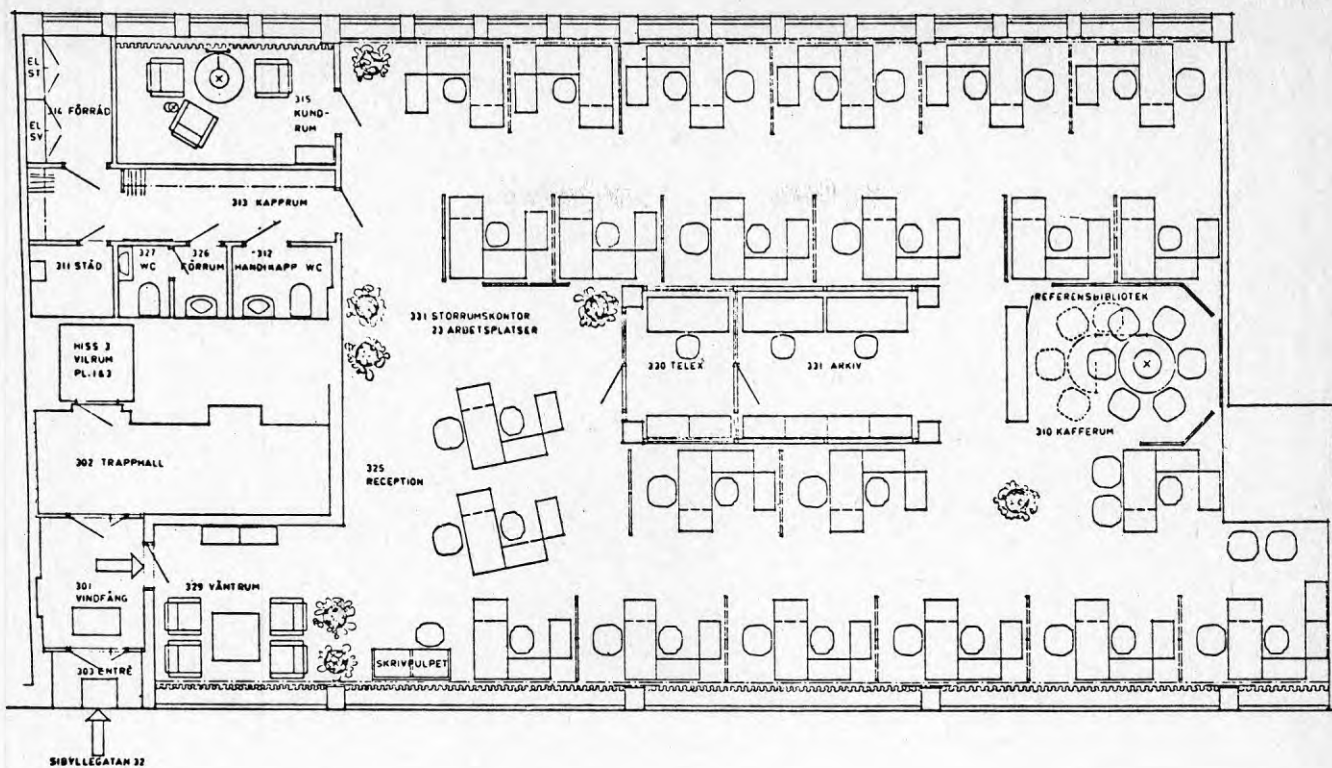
Storrumsplan. Alternativ 1. Plan, 1974-05-24.
